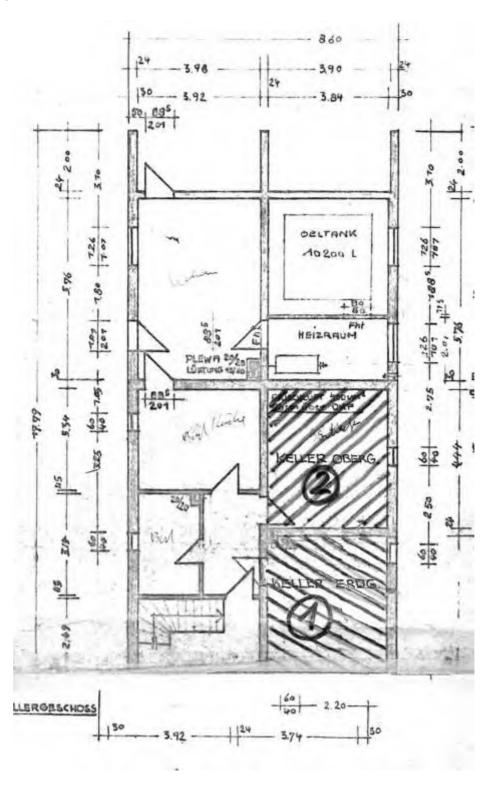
Grundriss Kellergeschoss (Nr.1 = Bewertungsgegenstand)
